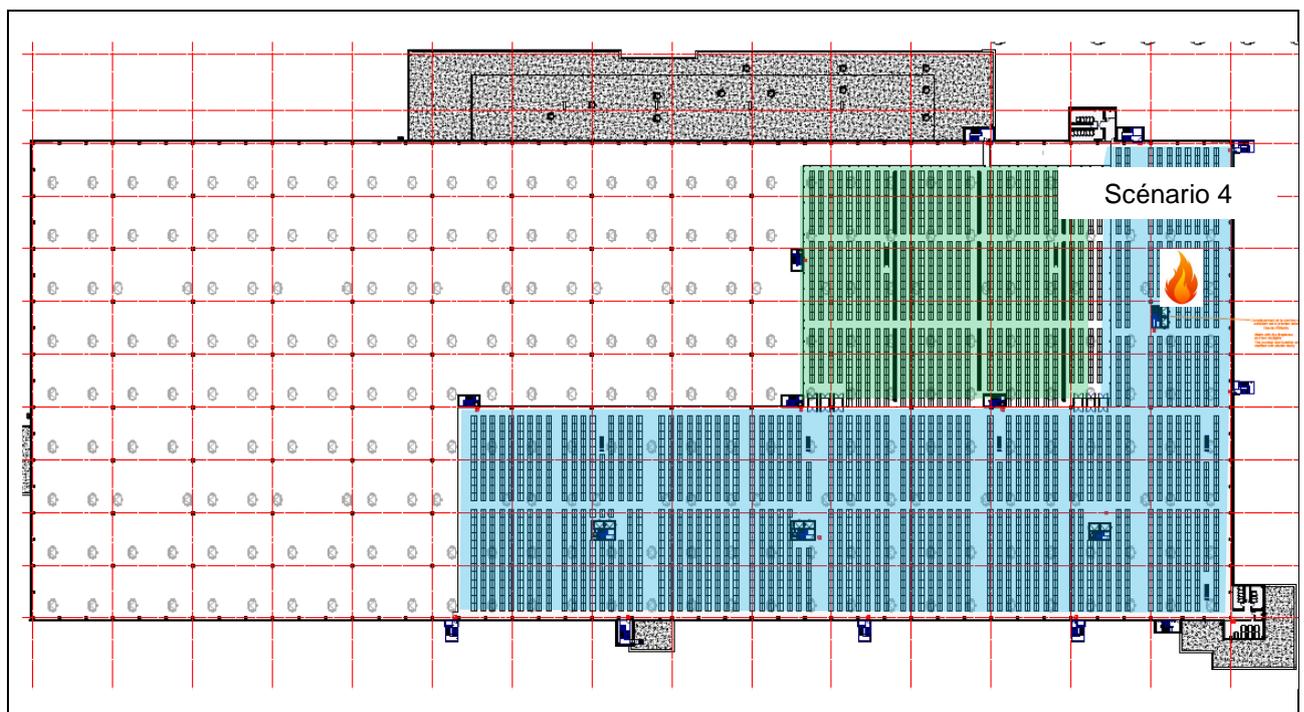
Position du scénario 4 dans la pick tower sur la mezzanine
